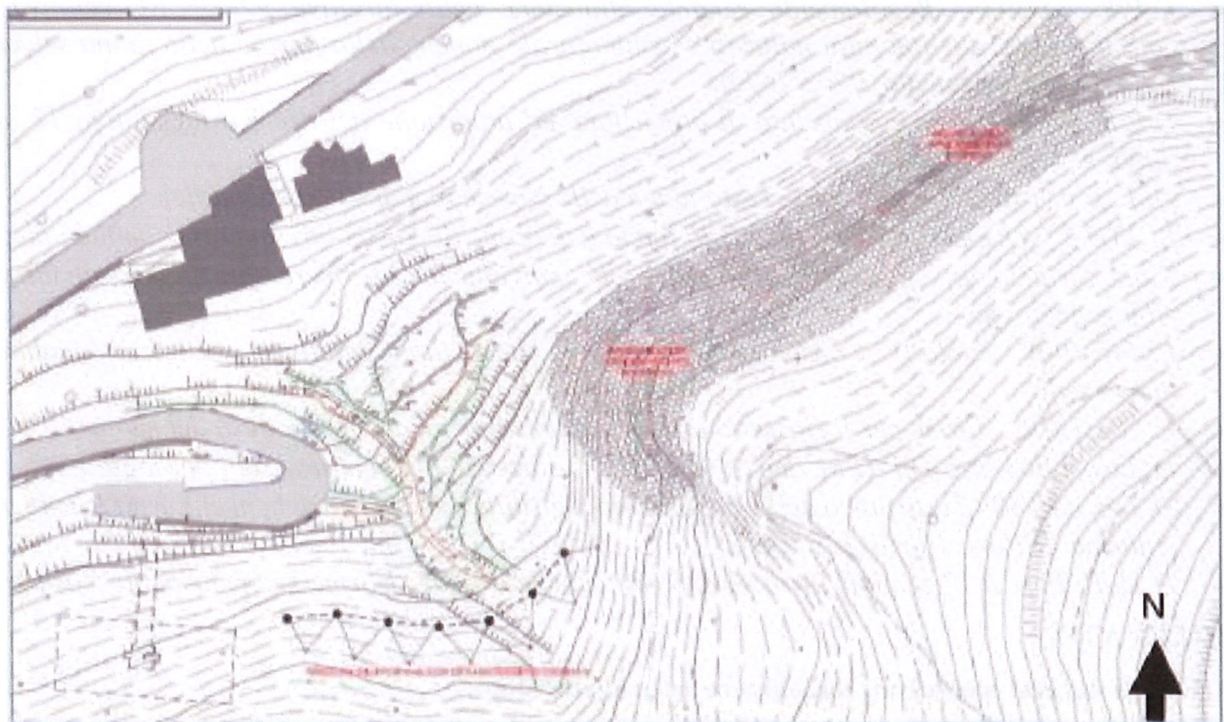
estratto da planimetria generale di progetto – ubicazione degli interventi
